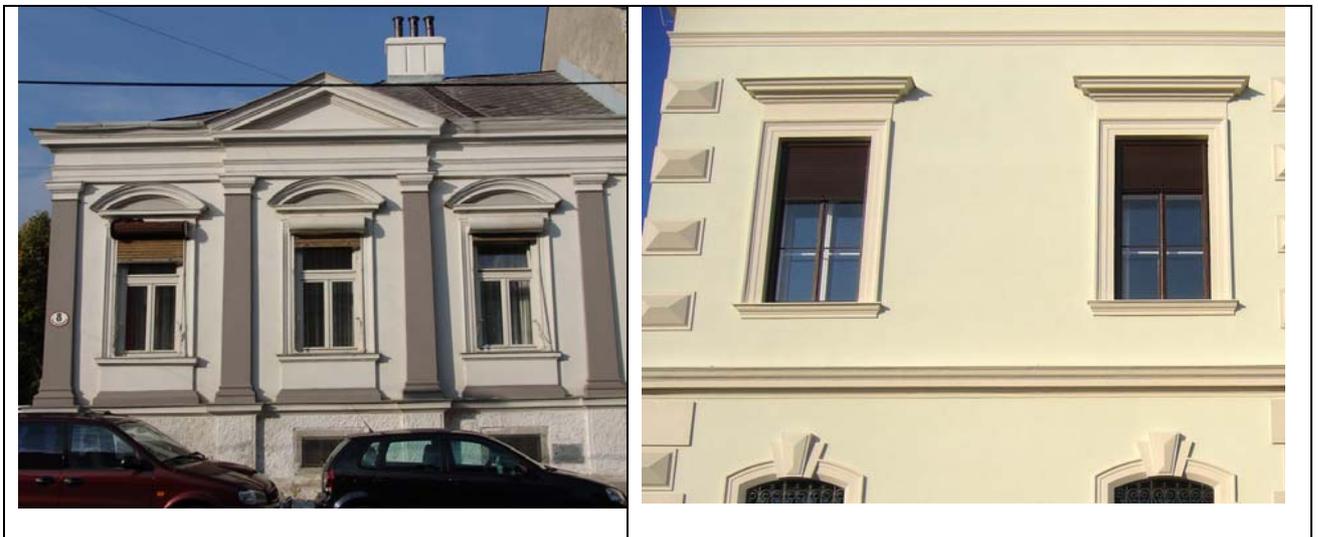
Denkmalgeschützte Gebäude mit außen montierten Rollläden (witterungsbeständig, formstabil)
